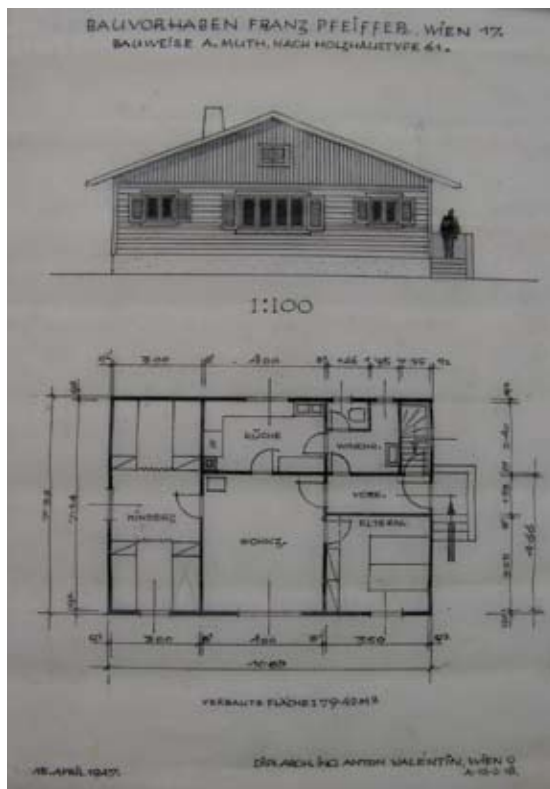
Plan 25.1: Anton Valentin. Bauvorhaben Franz Pfeiffer, Wien 17. Bauweise A. Muth. Nach Holzhaustype 61. Ansicht und Grundriss. Maßstab 1:100. 15. April 1947.
